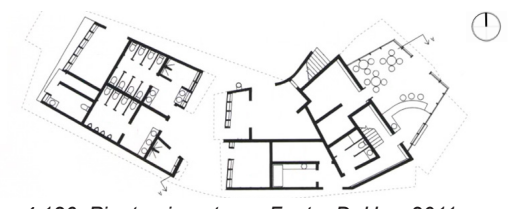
Pianta piano terra; Fonte: D. Hay, 2011;
